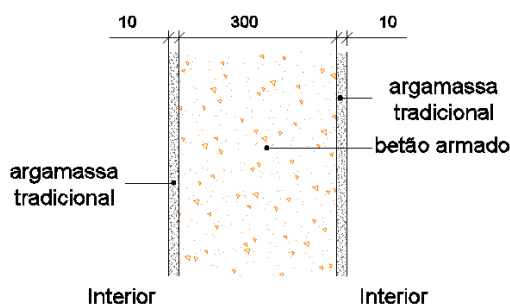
Pormenor das paredes da envolvente interior – PI1
